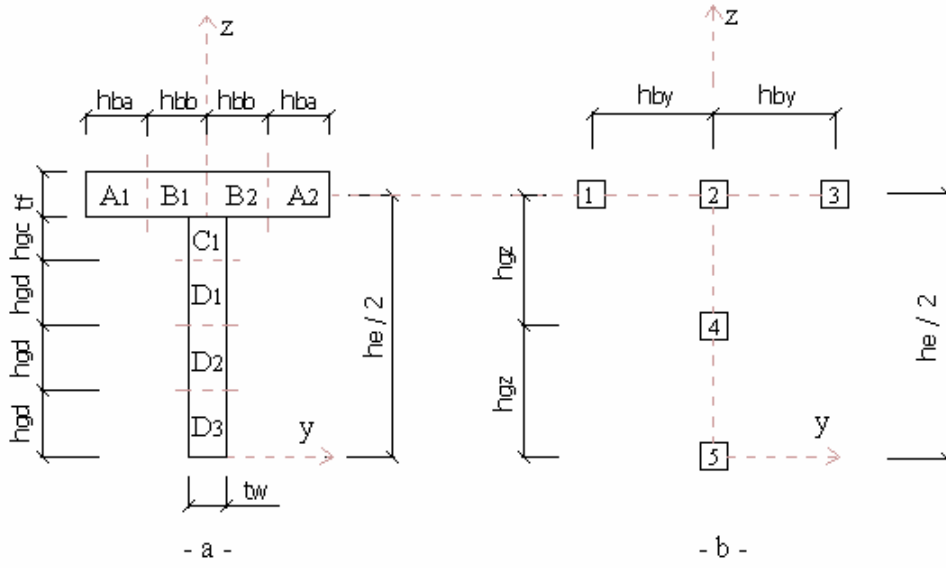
Kiriş kesitinin yarısı ve alan dağılımı (mm)
